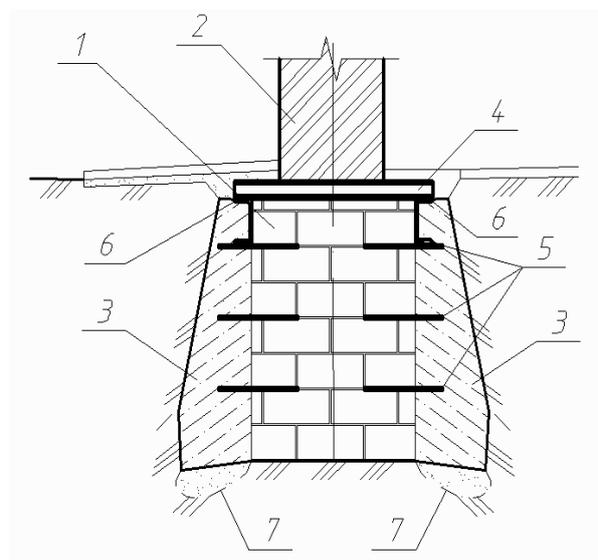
Уширение опорной площади ленточных фундаментов устройством приливов из бетона с установкой металлических балок и штырей: 1 – усиливаемый фундамент; 2 – кирпичная стена; 3 – приливы из бетона; 4 – металлические балки, устанавливаемые в пробитые отверстия; 5 – металлические штыри из арматурной стали; 6 – металлические балки, закрепляемые на сварке к поперечным балкам; 7 – зоны уплотненного грунта
